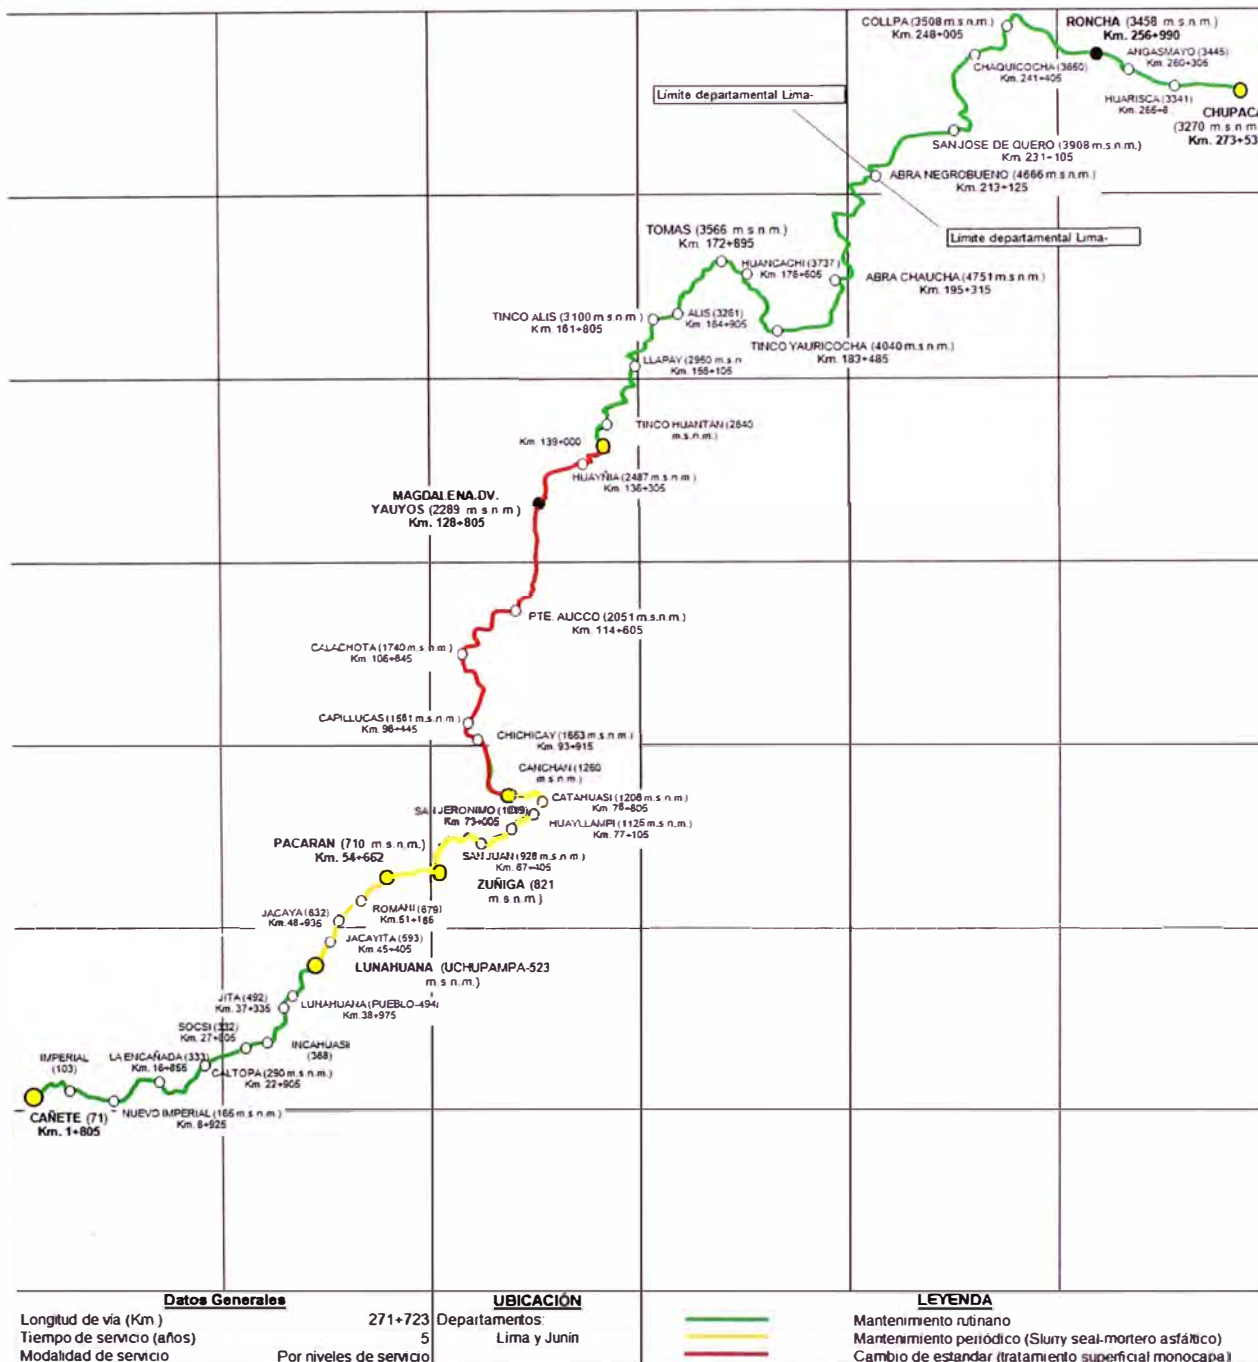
PLANO CLAVE DE LA RUTA 22
